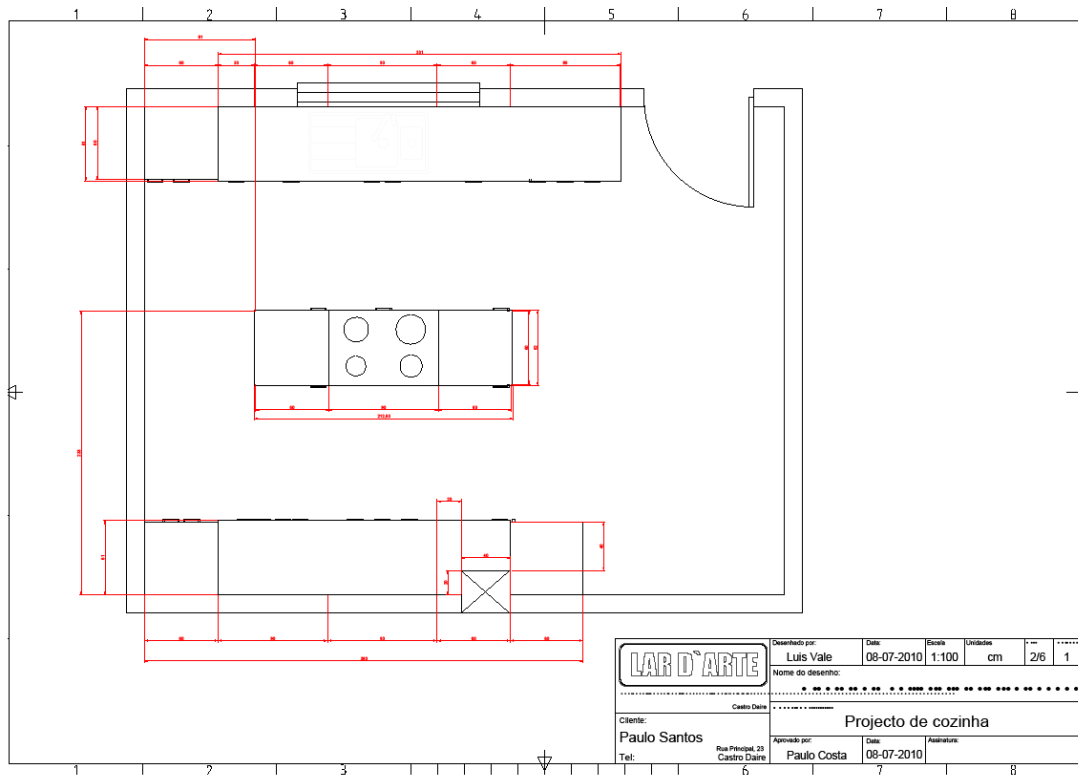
Planta cotada referente à disposição dos módulos no espaço
